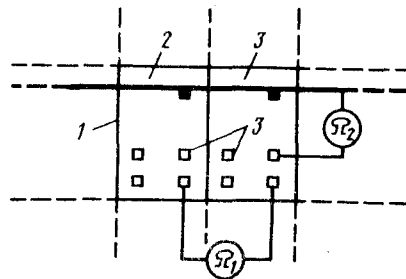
Схема проверки наличия металлической связи между арматурой железобетонных тубингов (Ω_1), арматурой и шиной заземления (Ω_2): 1 — тубинг; 2 — шина заземления; 3 — накладные детали
